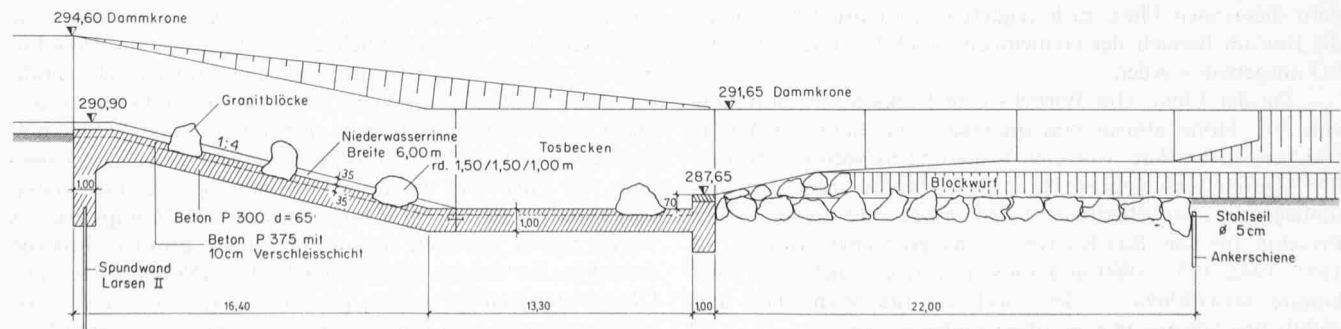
Wehrquerschnitt. Absturz von 3,25 m Höhe ausgebildet als Schrägrampe 1:4 mit einbetonierten Granitblöcken. Untergrund aus lehmigem Kiesschotter. Oberste Betonschicht von 10 cm mit abriebfestem Beton aus Quarzsand und Quarzkies
